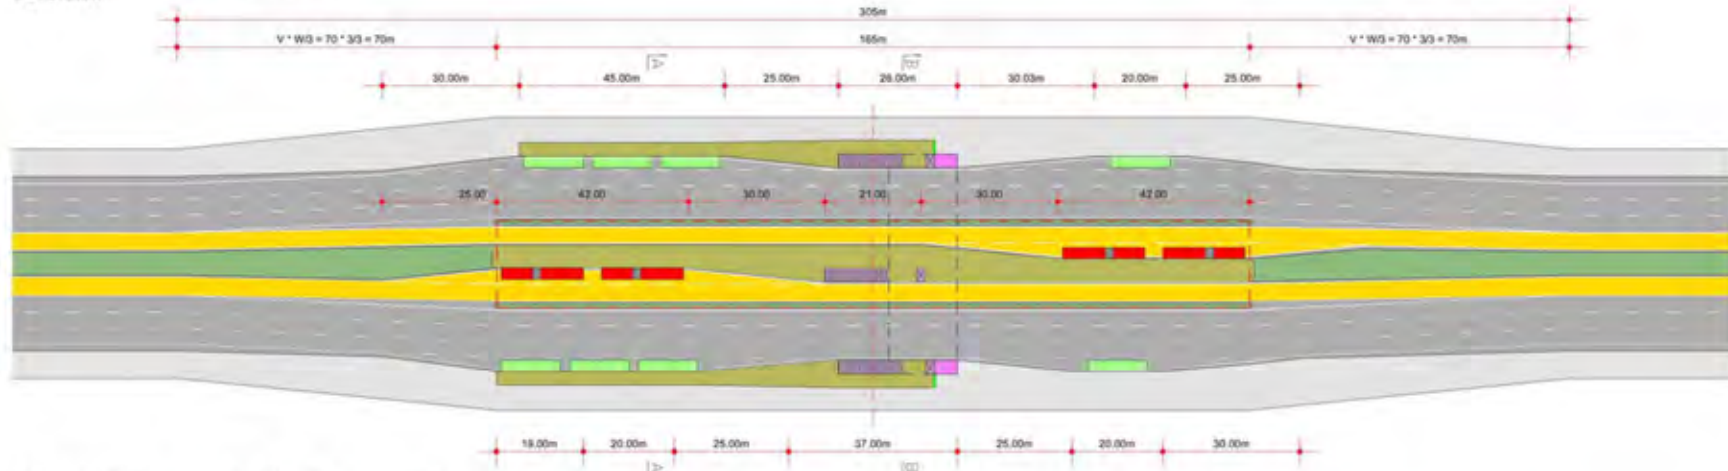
Planta baixa do Terminal Cidade Nova (proposta)
